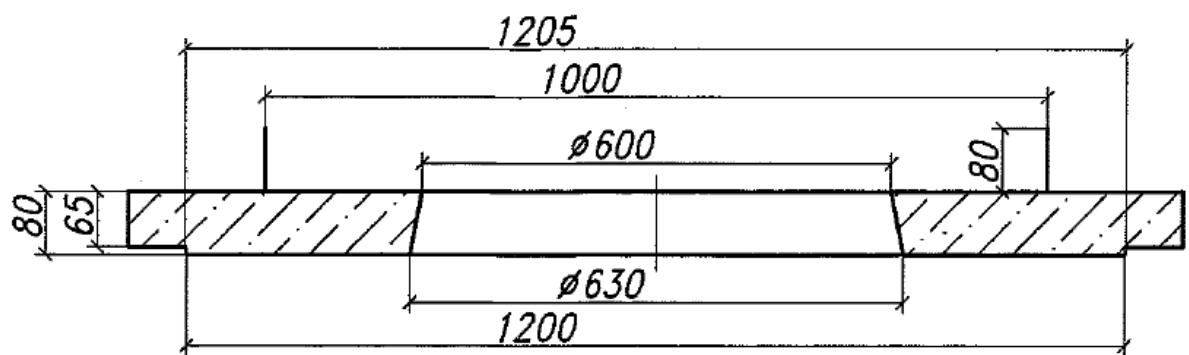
Размеры выступа на нижней стороне плиты перекрытия
